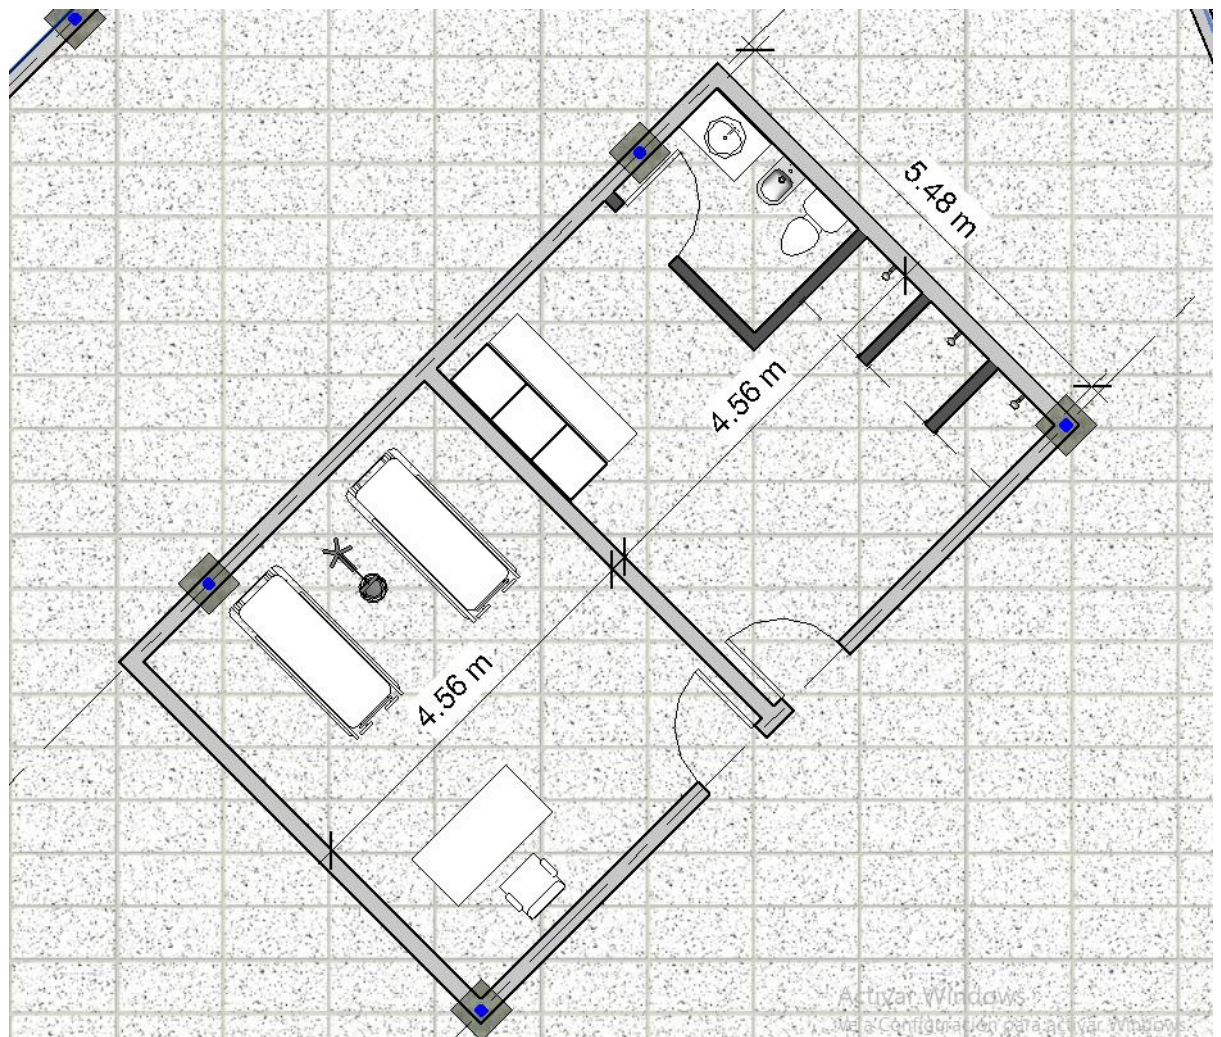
Vista en planta de la sala de primeros auxilios y el vestuario para árbitros. Fuente: elaboración propia
